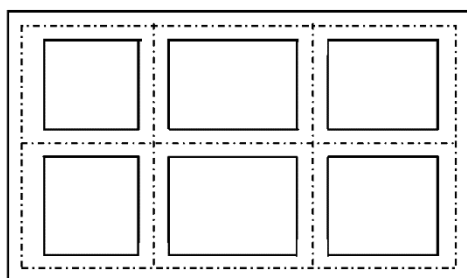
Sistema reticular de vigas de cimentación en sistema de muros portantes.
